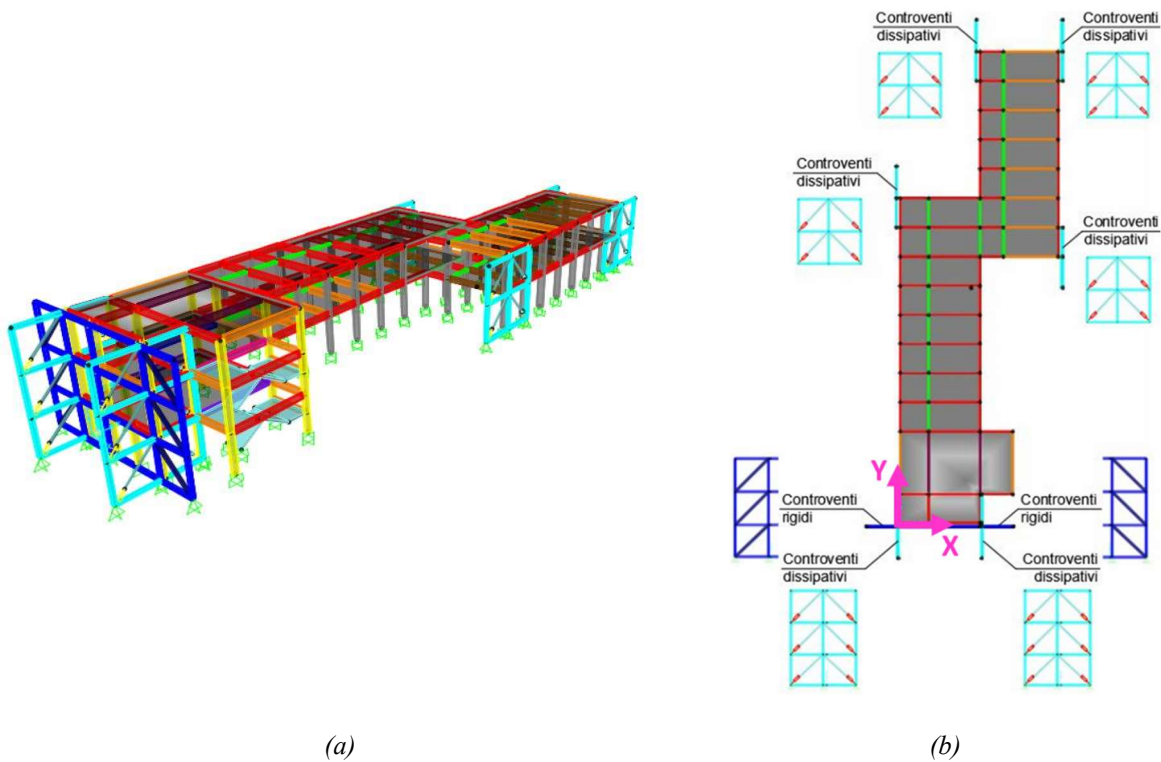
Proposta di intervento globale: (a) vista 3D e (b) disposizione in pianta dei telai controventati.
